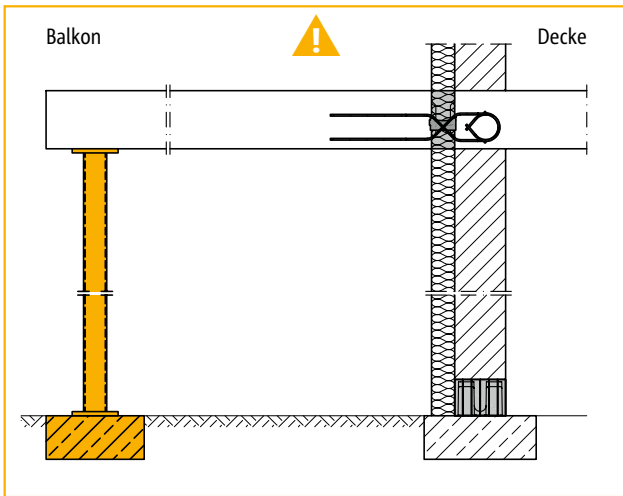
Einbausituation mit Schöck Isokorb® Typ Q70-H160
